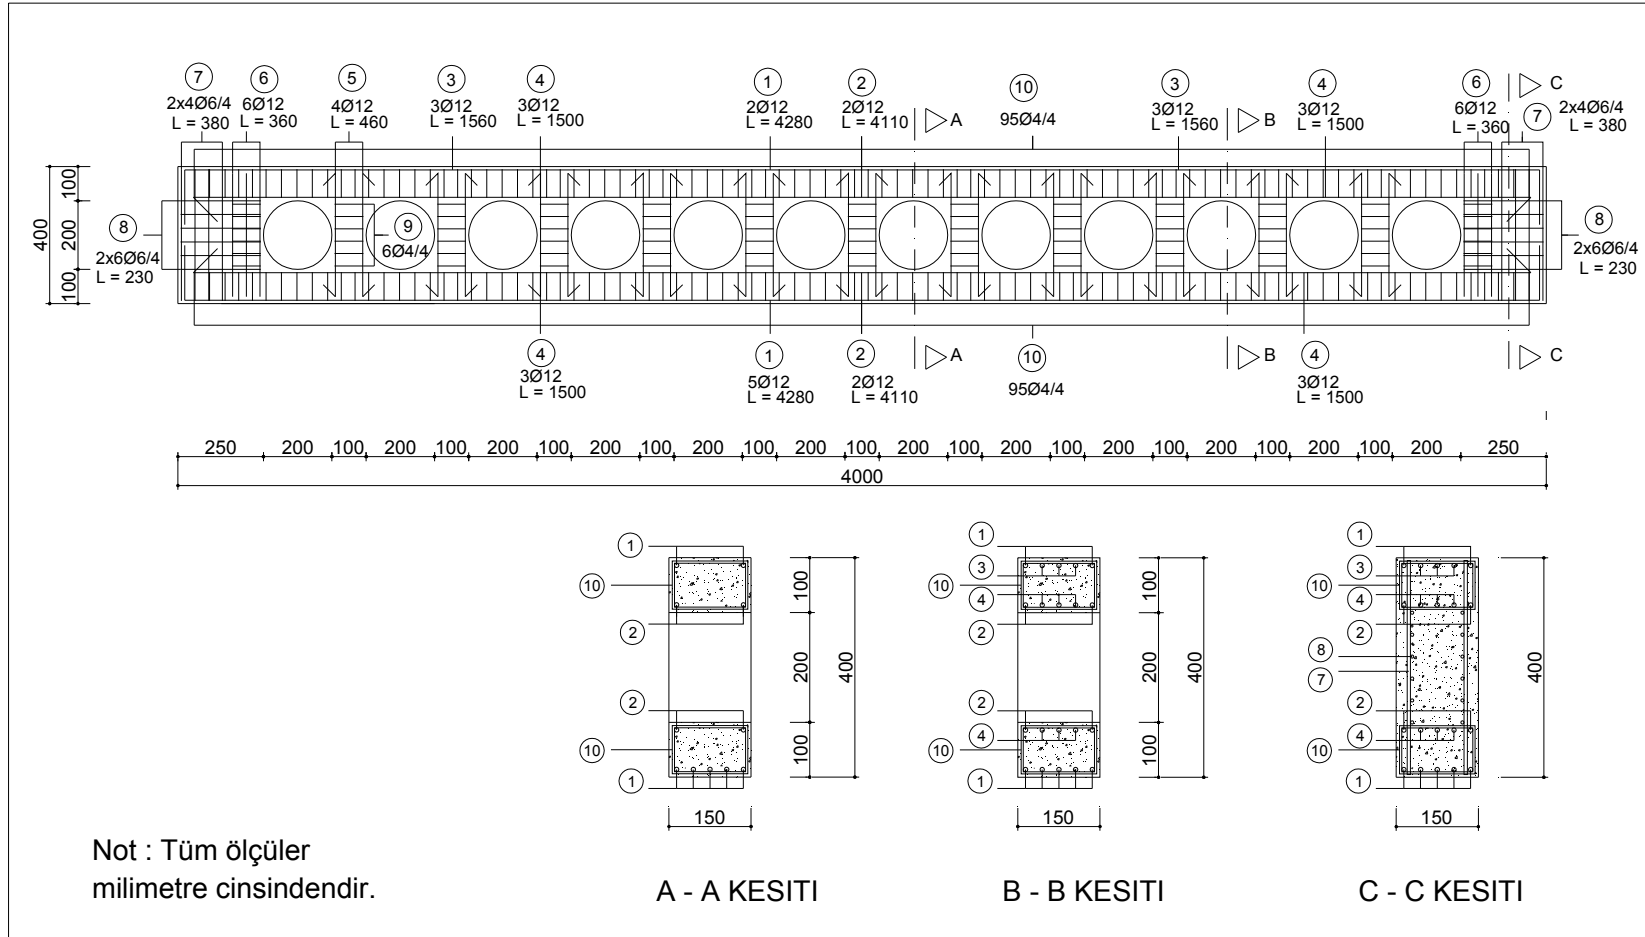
RCB kiriş donatı planı ve kesitleri
